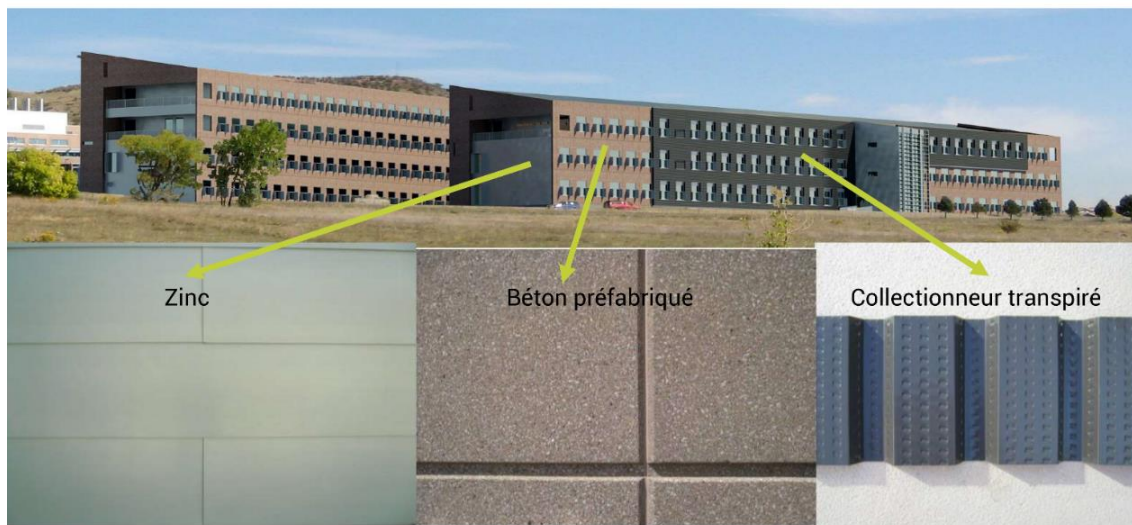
Traitement et matériaux de construction texture des façades dans le bâtiment RSF
